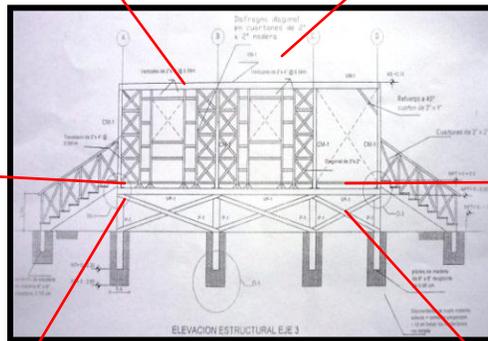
elevación estructural longitudinal de la vivienda nueva
